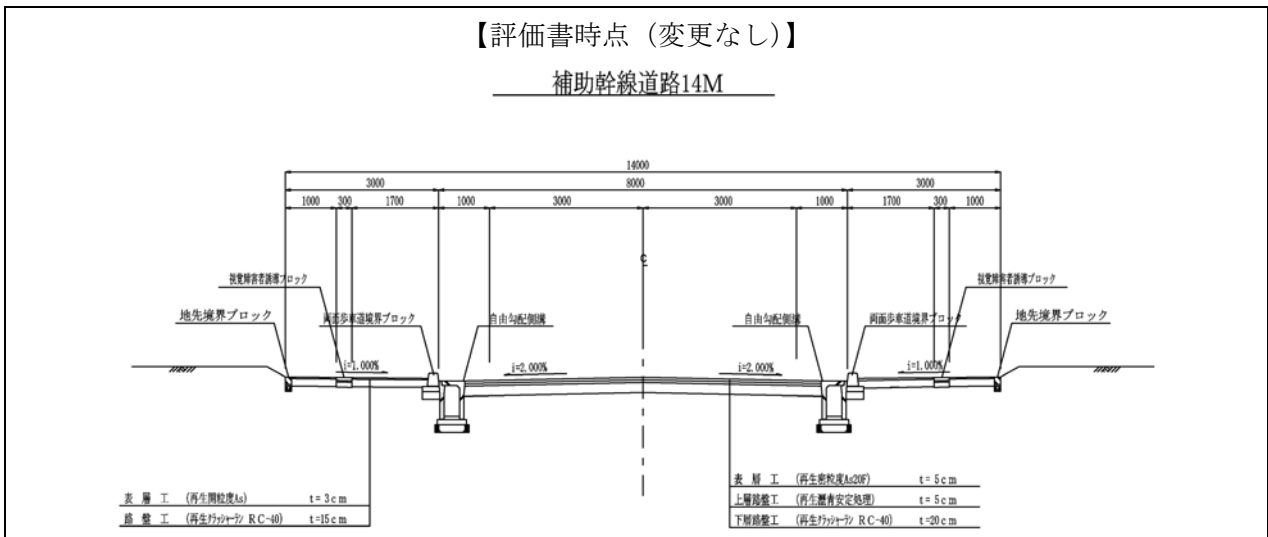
(2) 道路断面図(補助幹線道路:14m 標準断面)
